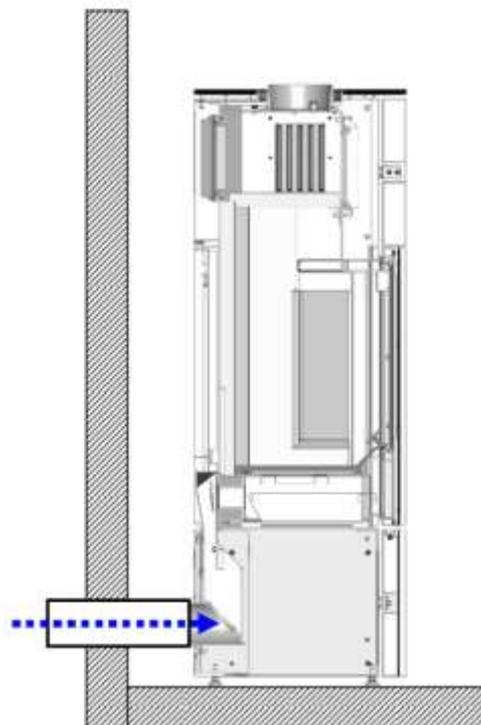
depuis la pièce adjacente ou par un conduit
